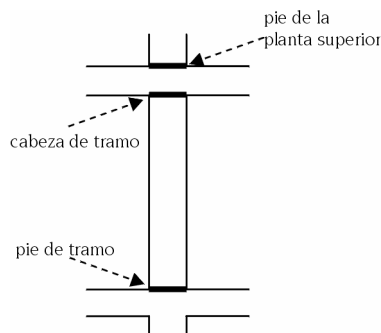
SECCIONES QUE SE COMPRUEBAN EN UNA PLANTA
